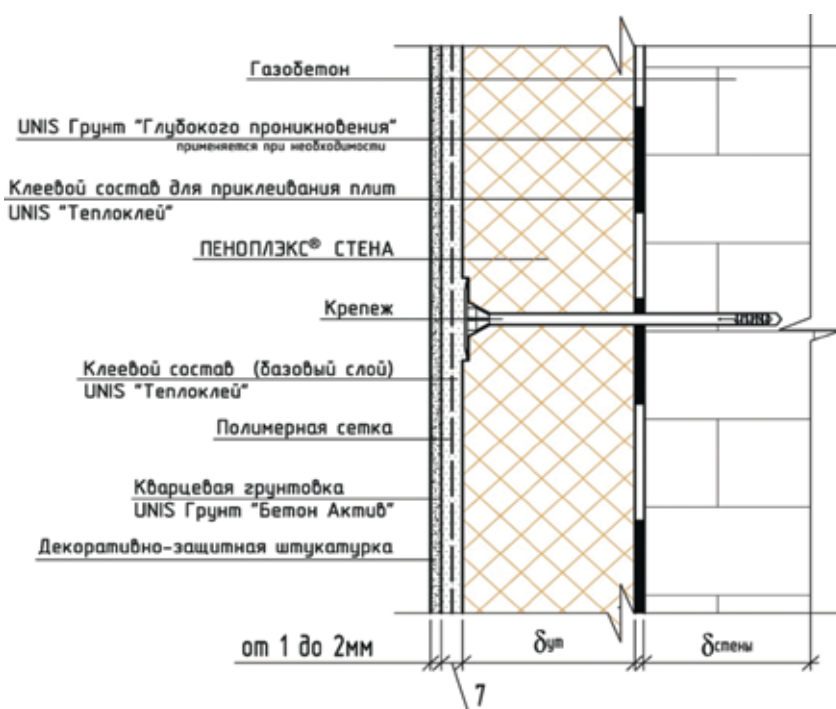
Конструкция наружной стены здания № 1 (газобетон – ПЕНОПЛЭКС Стена – тонкослойная штукатурка)
